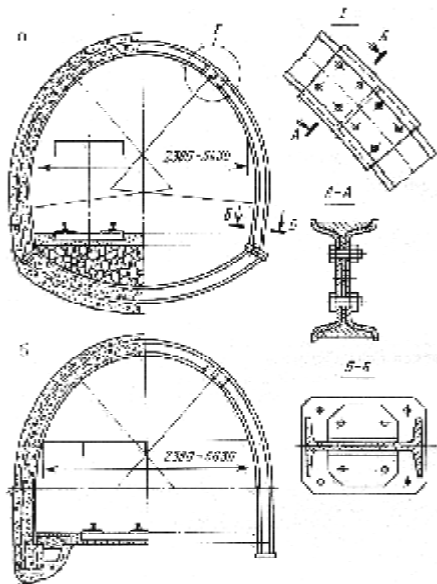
Металобетонне кріплення з жорсткими рамами із двотавру:
